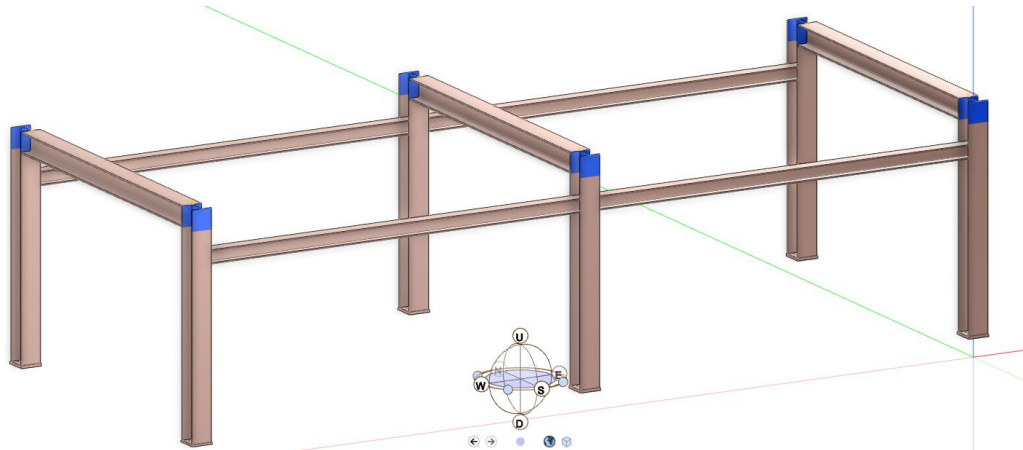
Rack principal con la modificación de los apoyos de la viga en azul.
